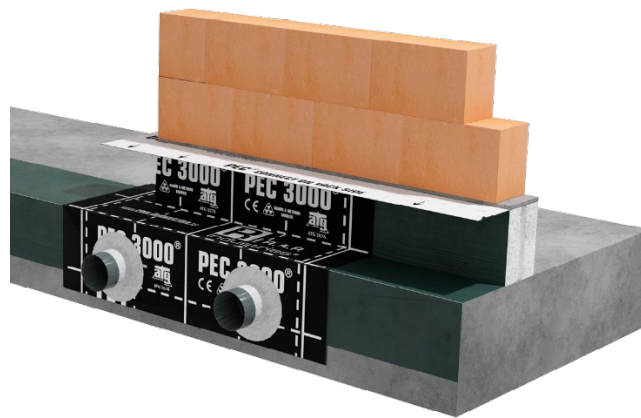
Waterdichting ter hoogte van doorvoeren in betonnen elementen
